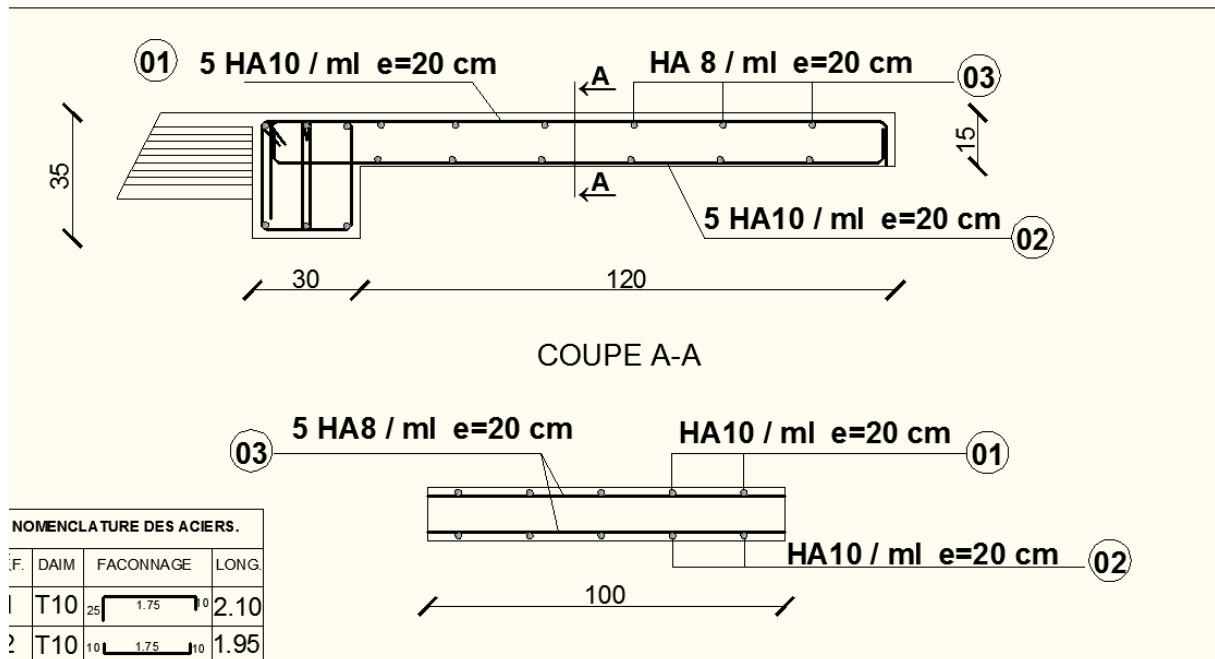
Schéma de ferrailage de la dalle de du balcon
